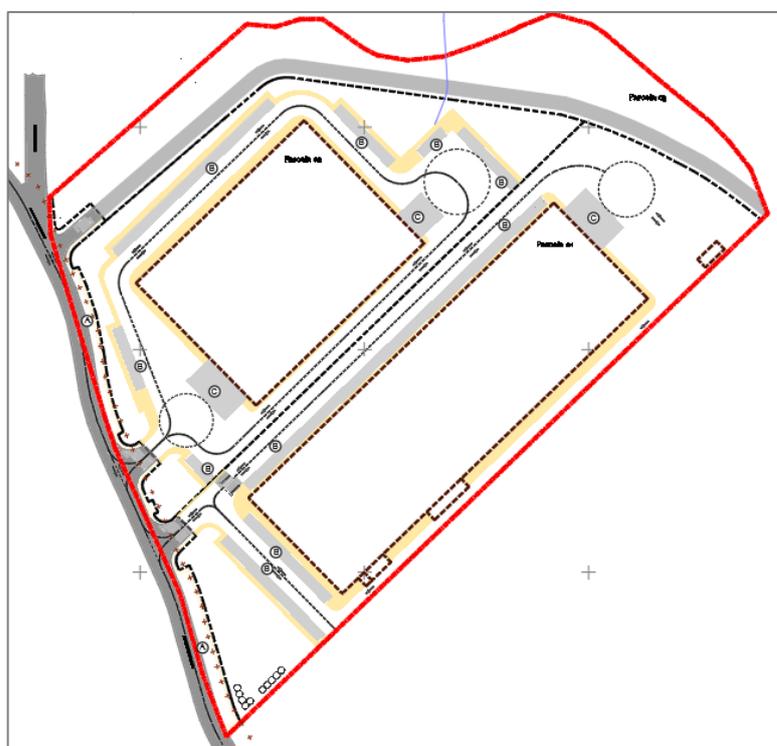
Sentidos de trânsito previstos na proposta de plano.
